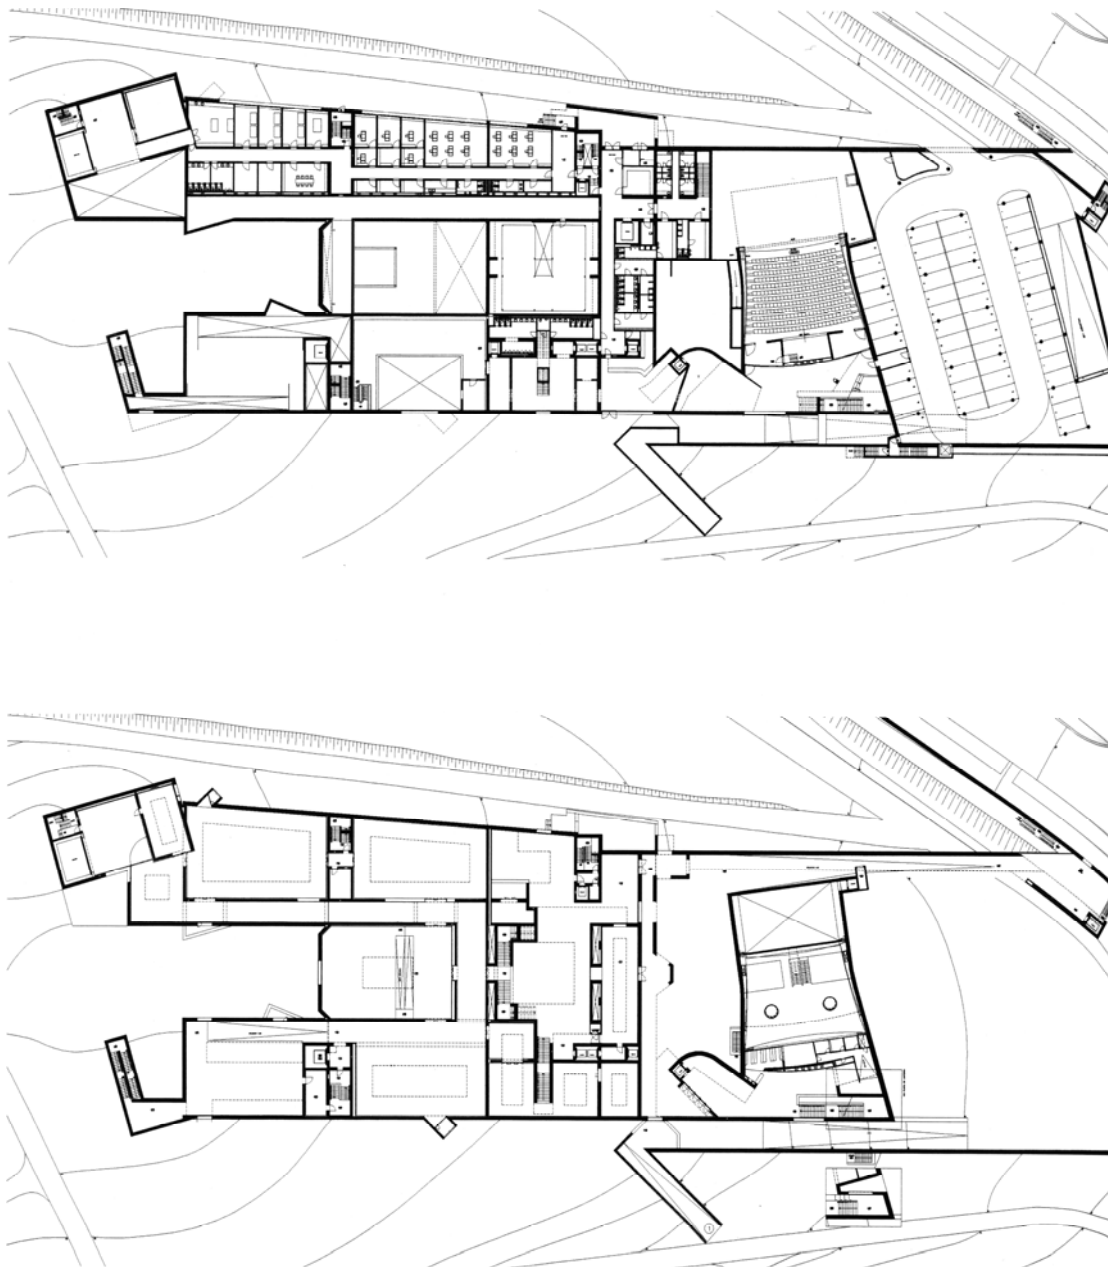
Serralves. Plantas do segundo e terceiro pavimentos.
